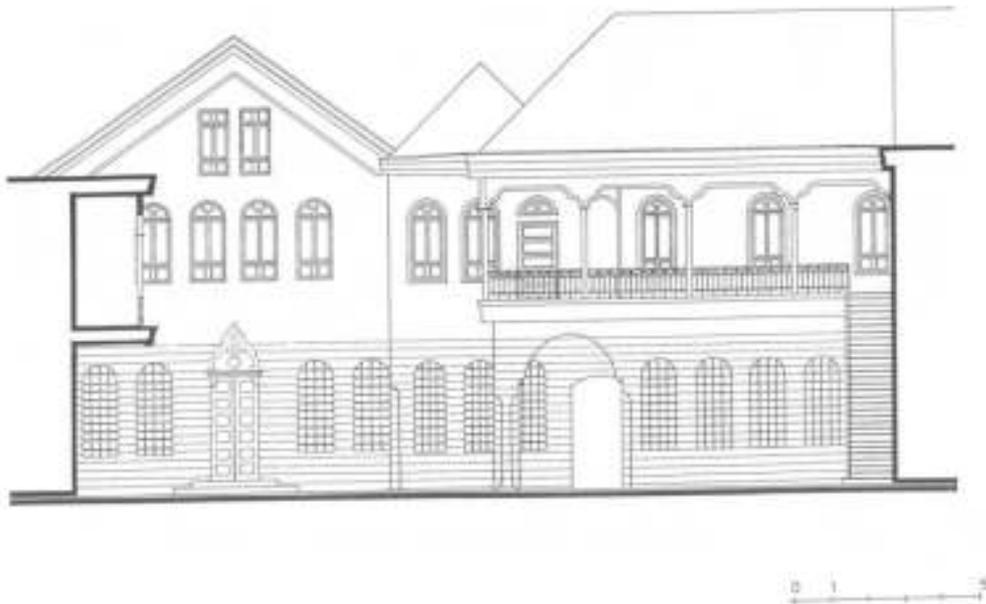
24. Casa Anbar: Fachada interior. KABREET,Z., "AL-Bayt Damashqī", Damasco, 2000, pp.120-129
